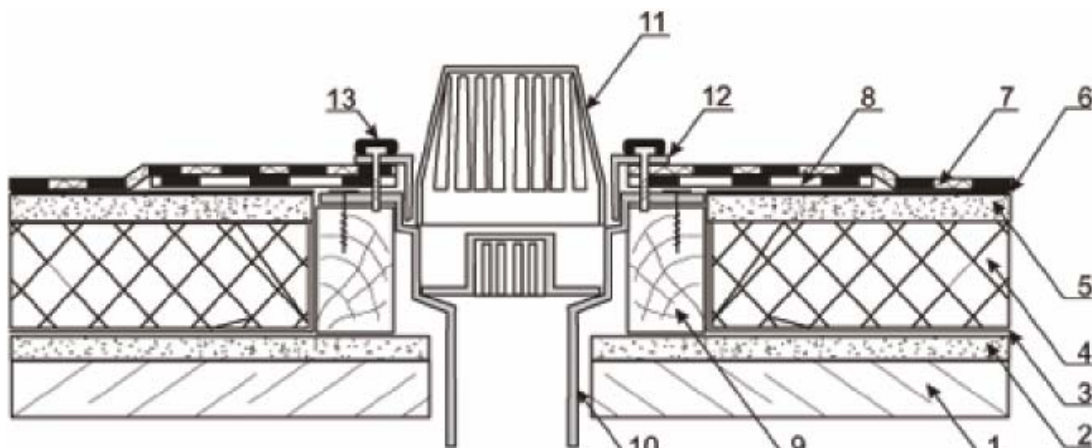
Примыкание кровли к водоприемной воронке для традиционной кровельной системы (Неэксплуатируемое покрытие).
